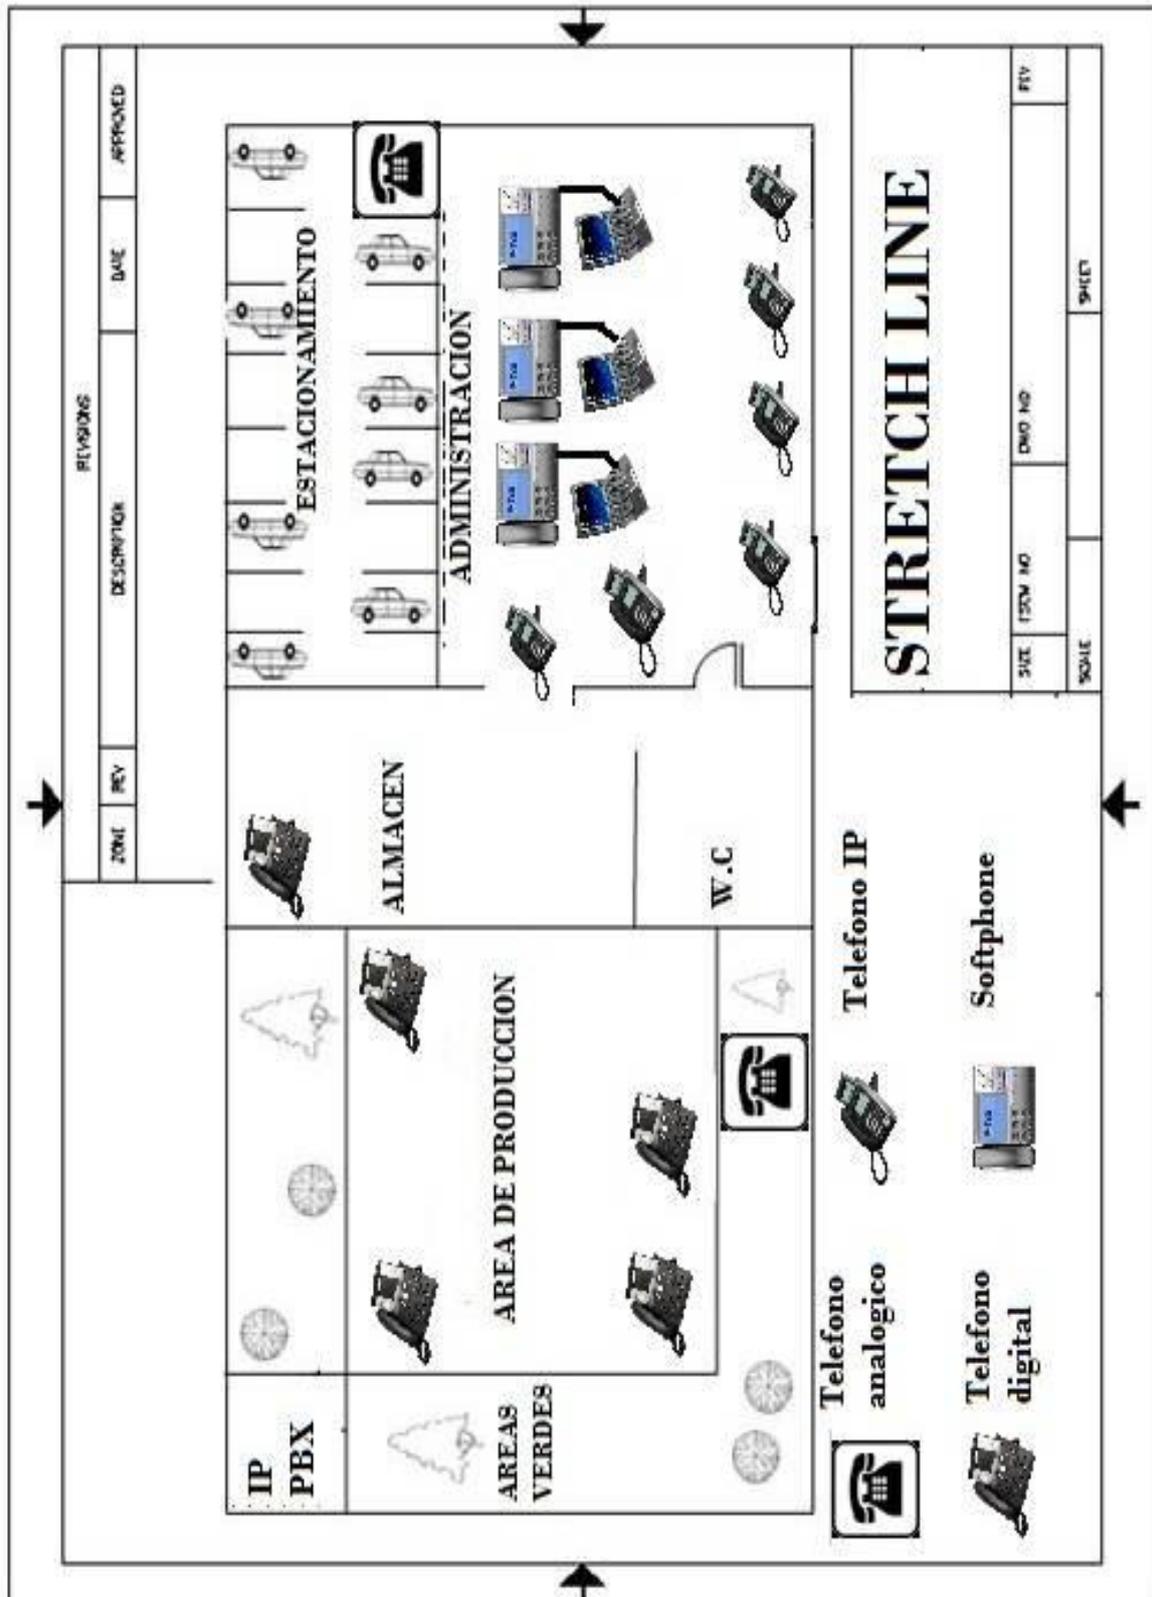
Plano de la red telefónica en la empresa Stretchline.
